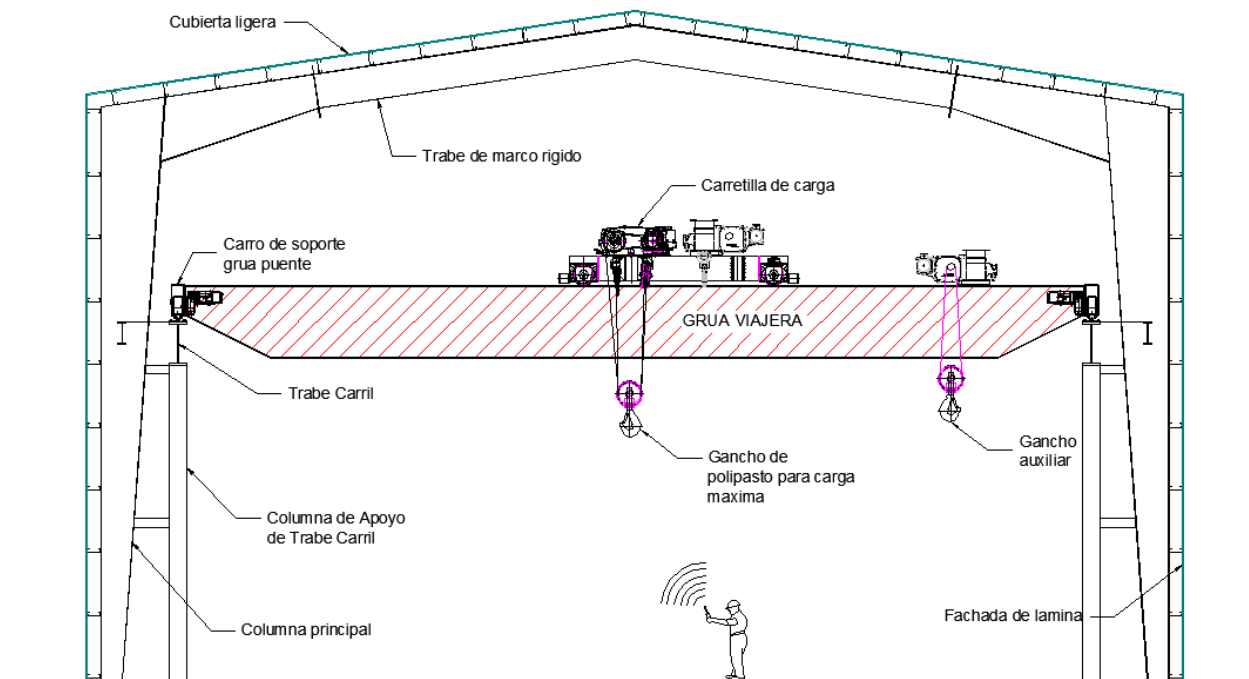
Estructura principal a base de columnas de acero de sección variable con adosó de columna para apoyo de trabe carril y trabe de acero de sección variable a dos aguas para la cubierta
